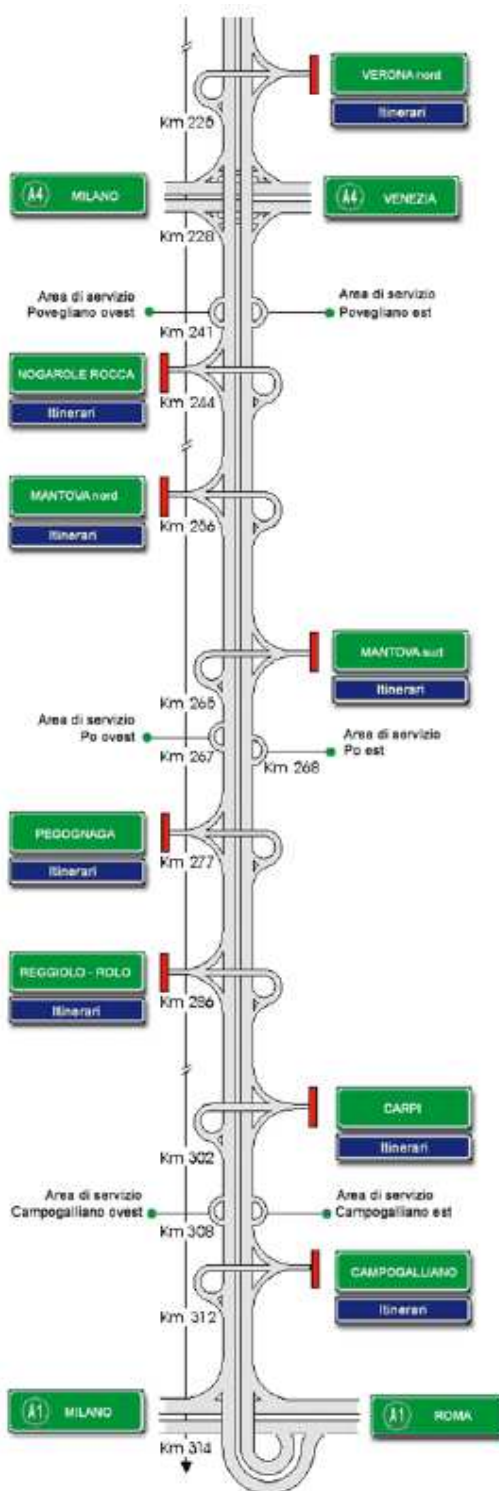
Schema tratto autostradale oggetto dell'intervento
